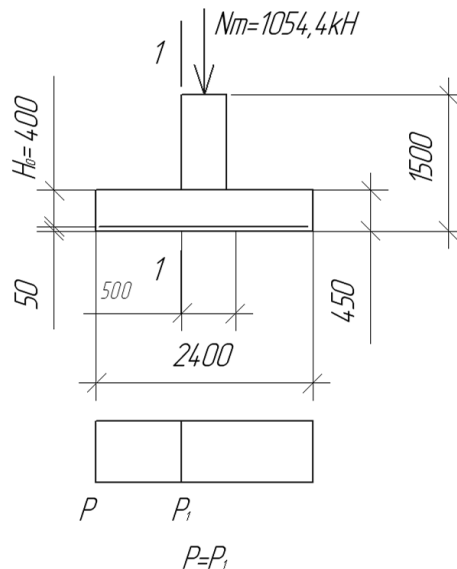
До визначення площі перерізу арматури підосви фундаменту ФМ-1
